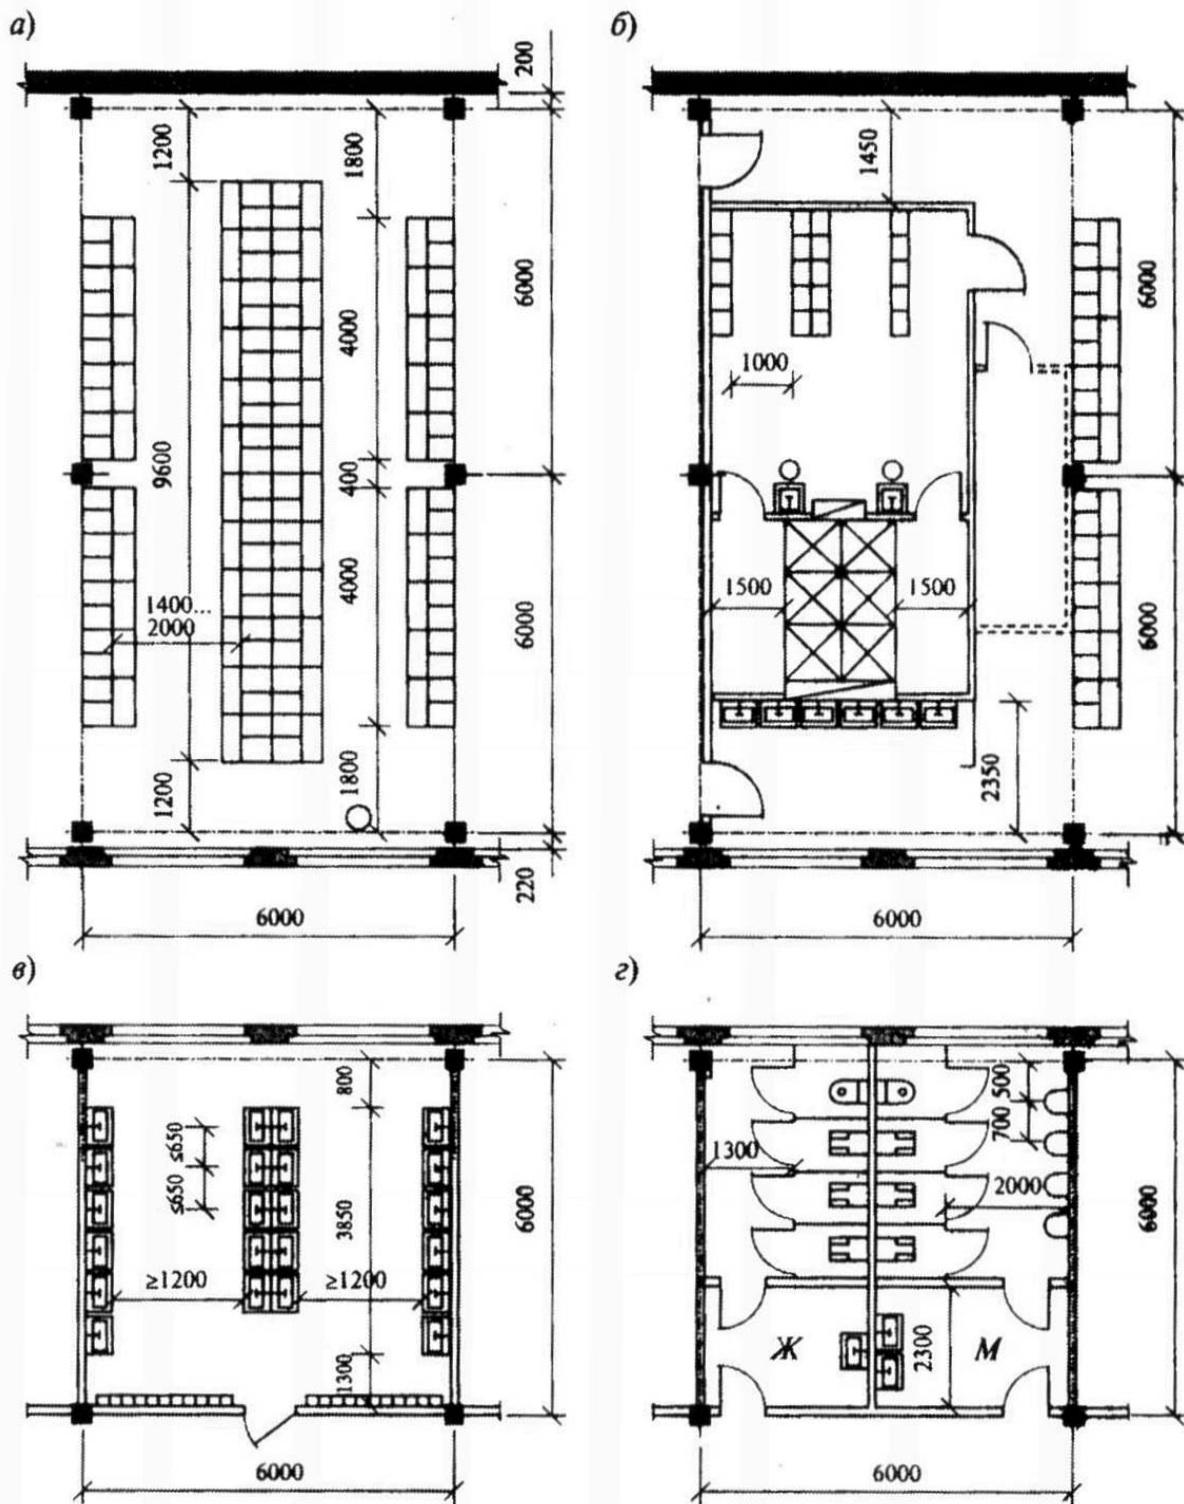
Примеры планировок отдельных бытовых помещений:
